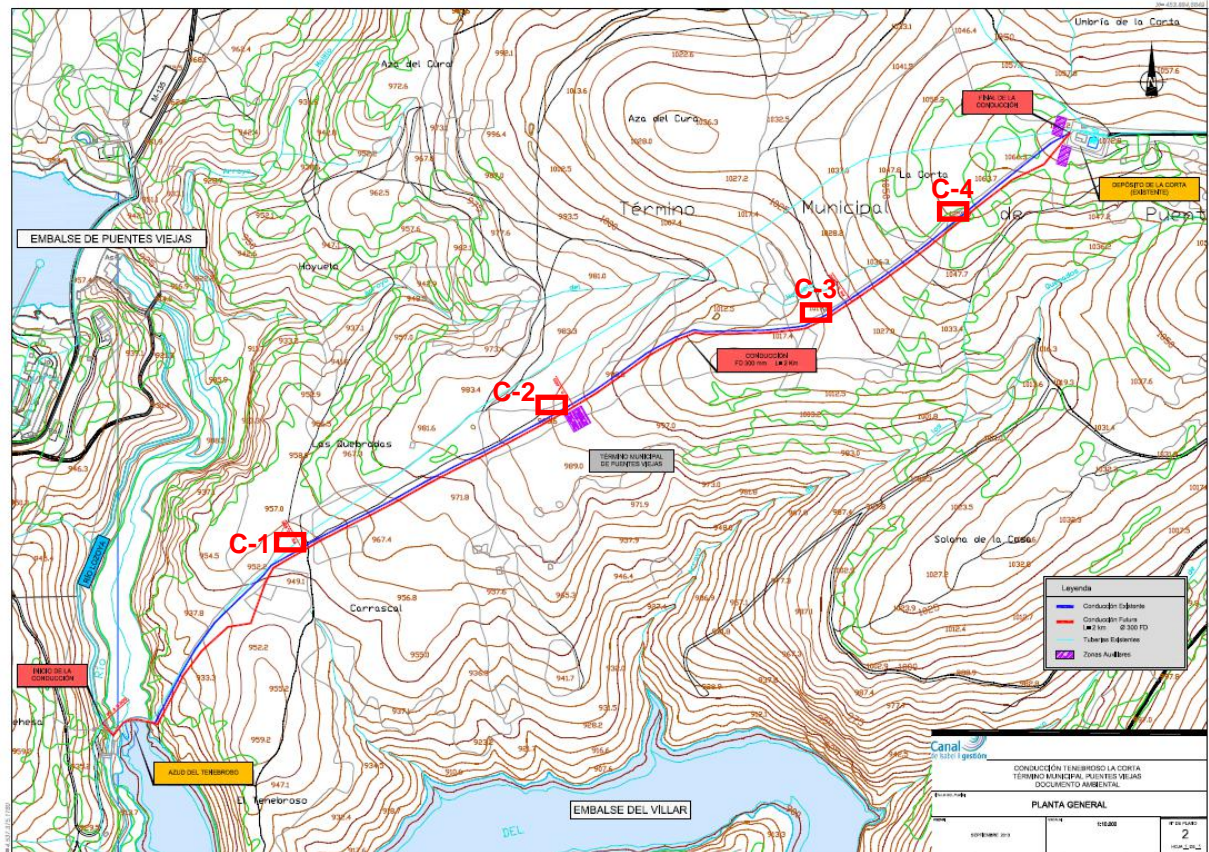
Plano de planta general donde se localizan las 4 calicatas realizadas a lo largo del trazado de la conducción.
